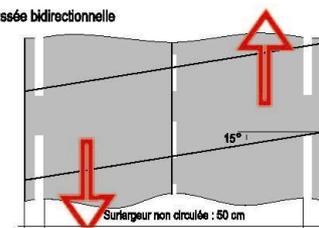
Joints inclinés de 15° ; dans le cas de chaussées monovoies à sens unique, les joints sont sciés perpendiculairement à l'axe de la voie
